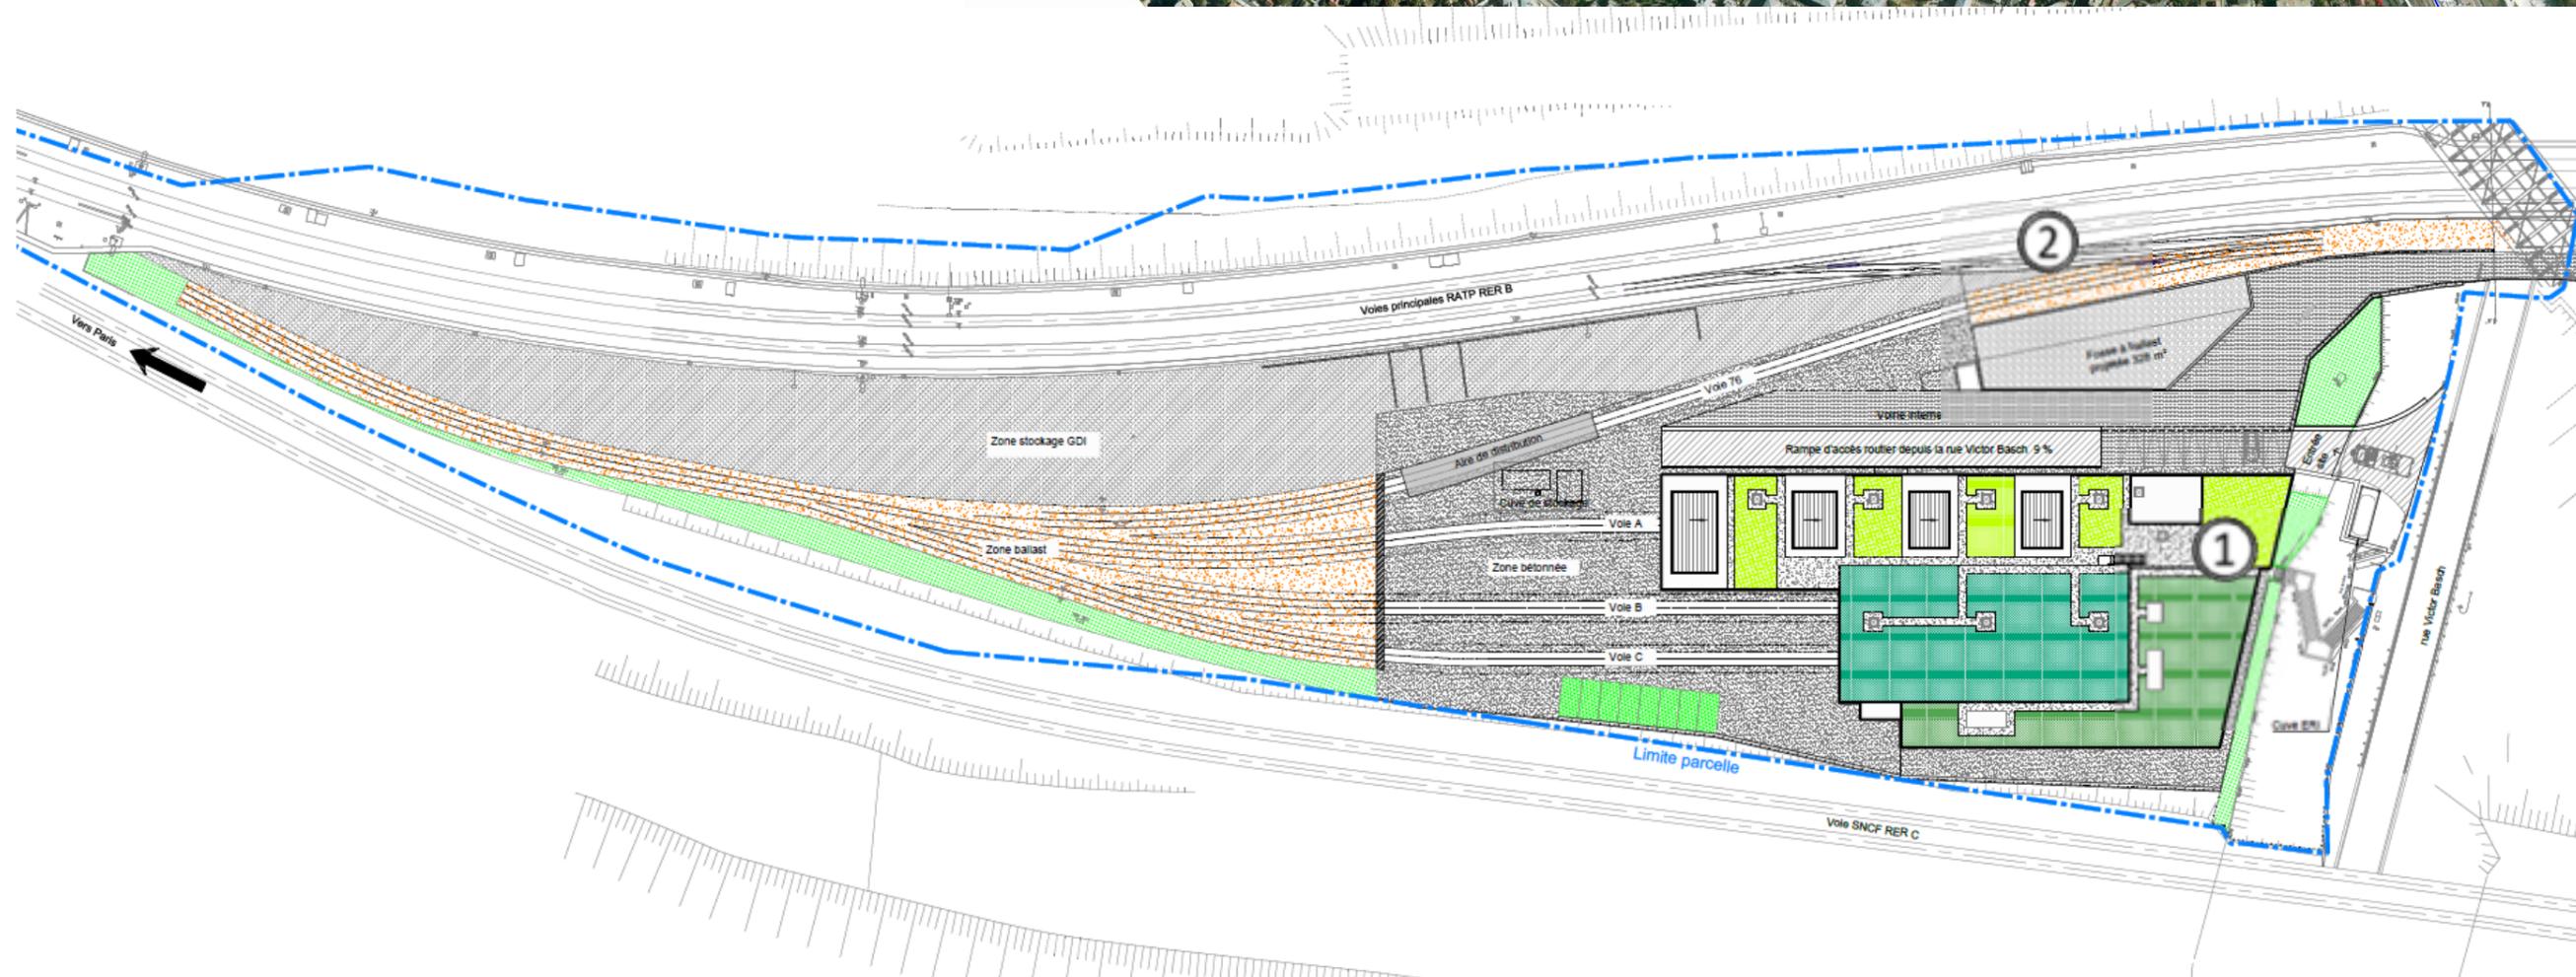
Extrait du projet de réaménagement du site ferroviaire de Massy : Construction du nouveau hall VMI (Source : RATP)
